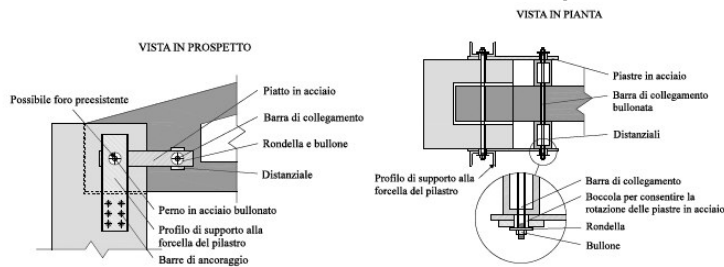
Intervento su connessione trave-pilastro mediante perni e piastre in acciaio
